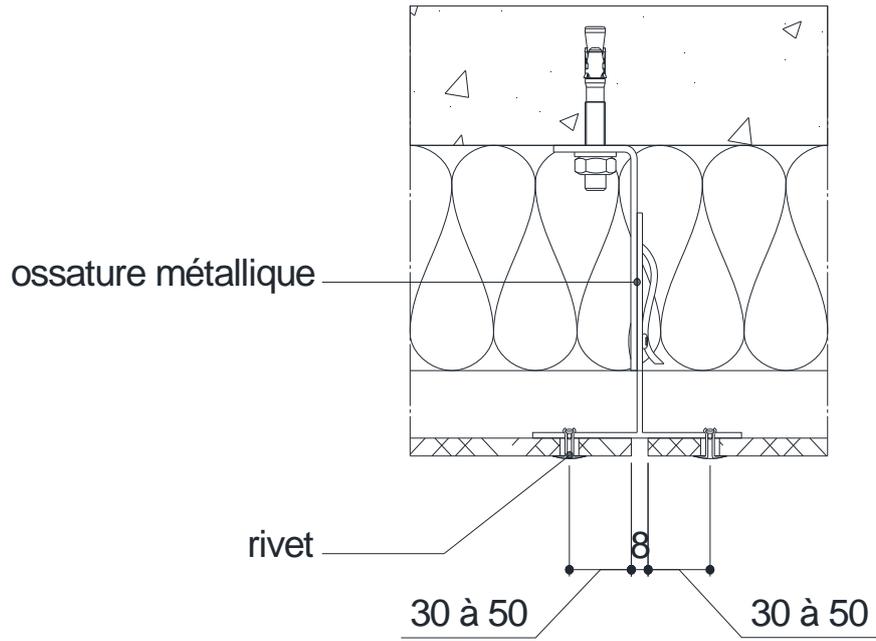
Joint vertical (coupe horizontale) sur ossature métallique (cote en mm)
